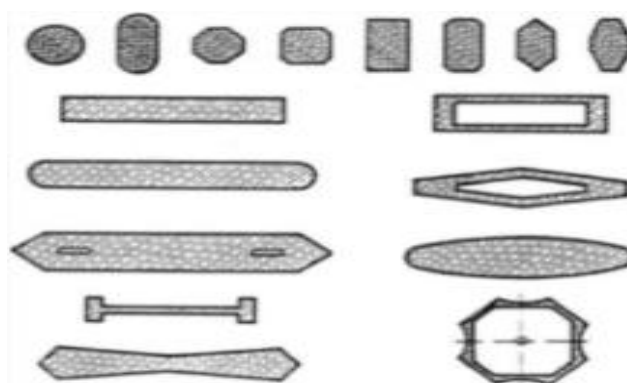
Seções Transversais de Pilares de Pontes (EL DEBS e TAKEYA, 2009)
